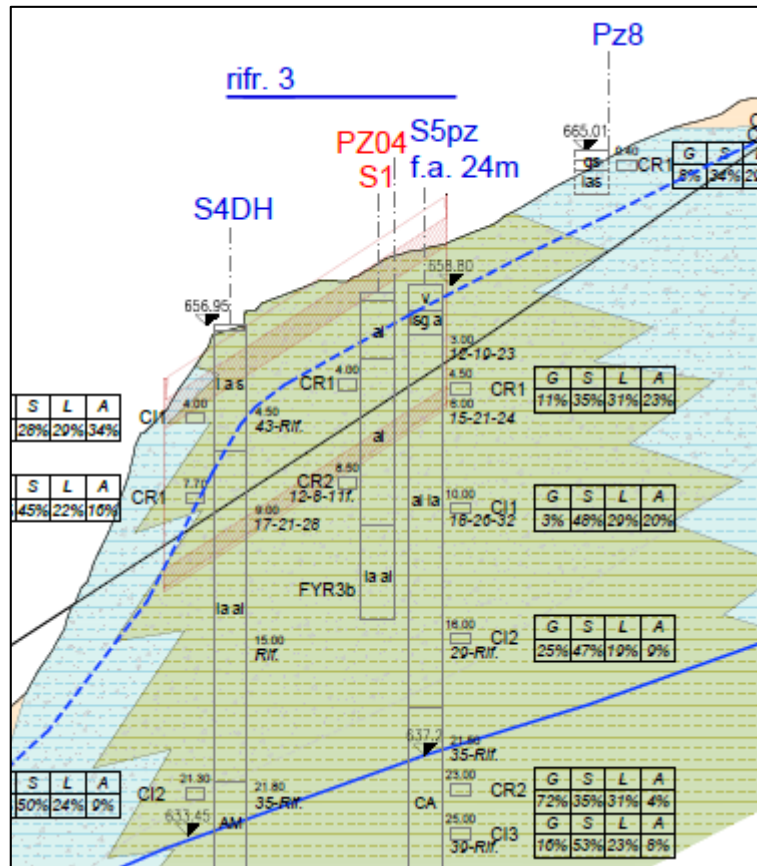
Stralcio del profilo geologico in corrispondenza della galleria artificiale in progetto
